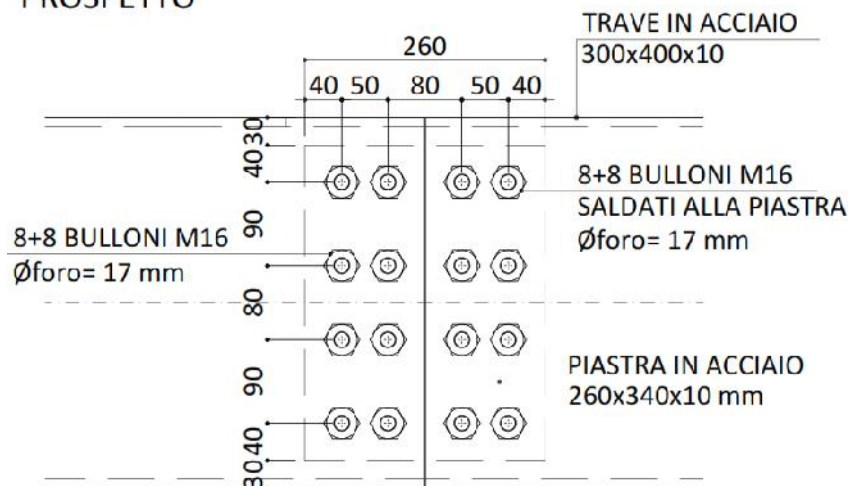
Giunto bullonato di continuità, vista in prospetto
